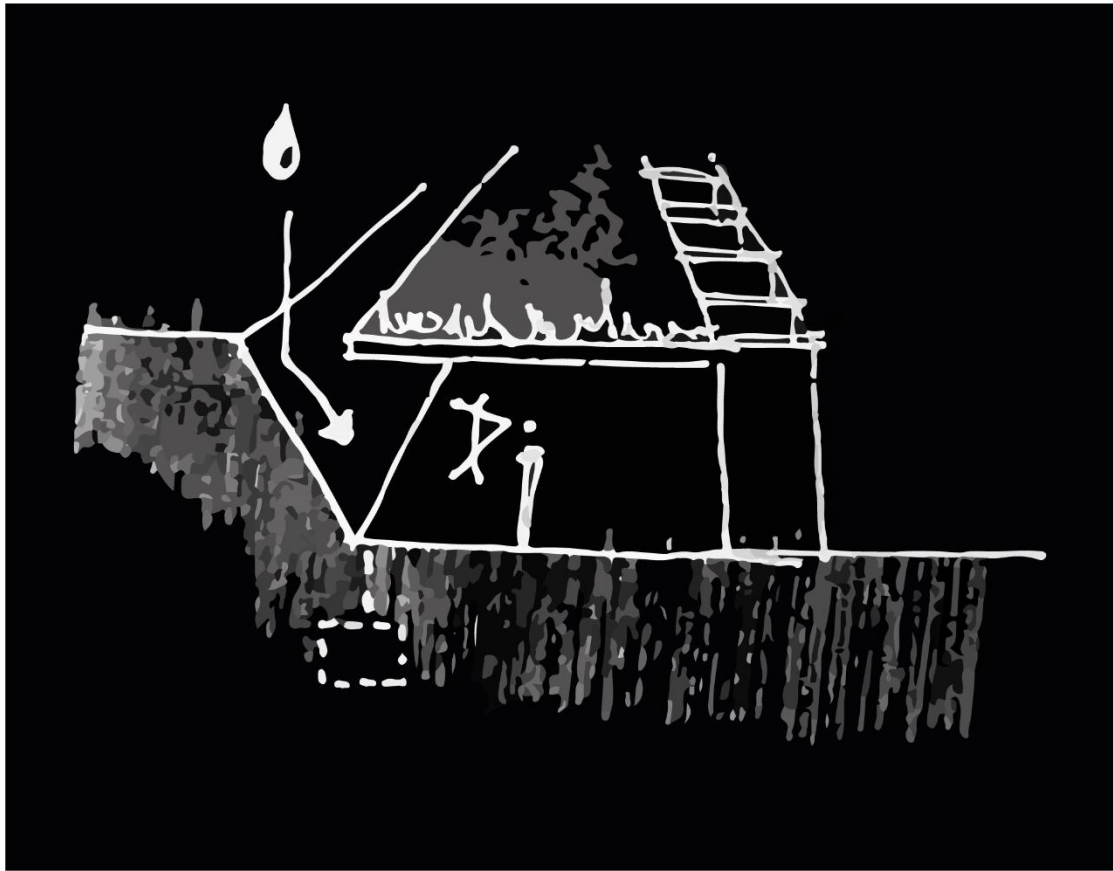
Esquema espacial de apertura en cubierta y vínculo con el exterior; elaborado por Verdugo, X. 2020
